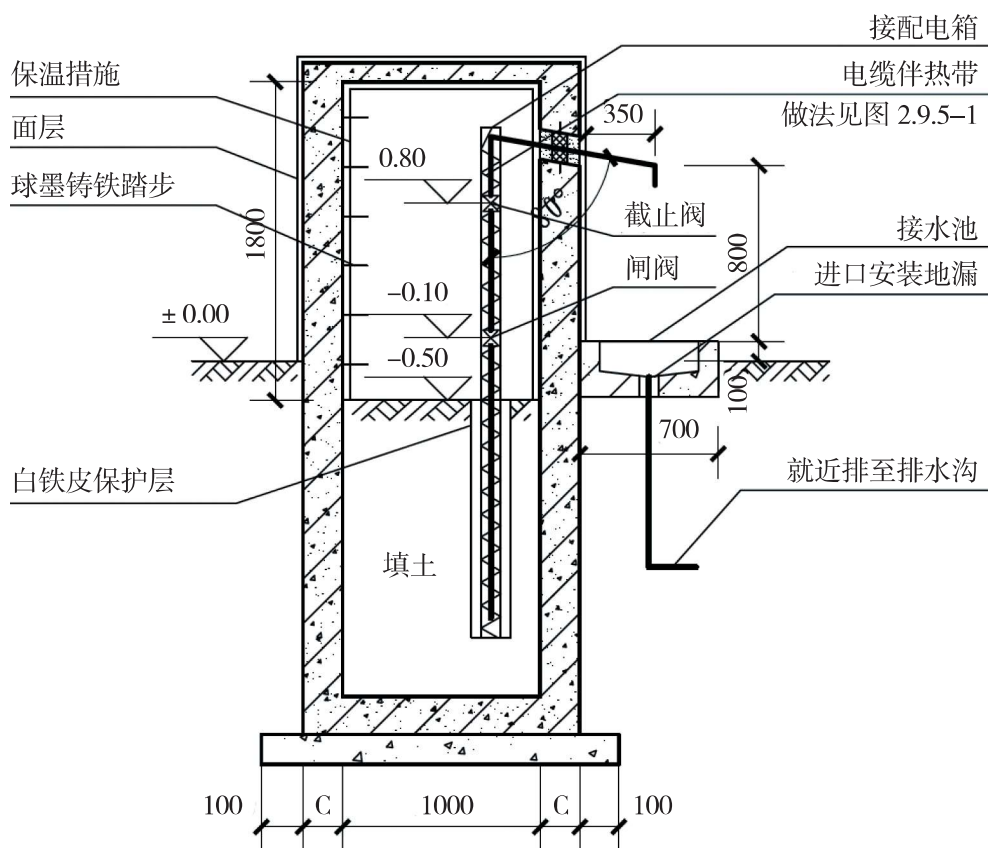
防冻给水栓安装 1-1 剖面示意图
